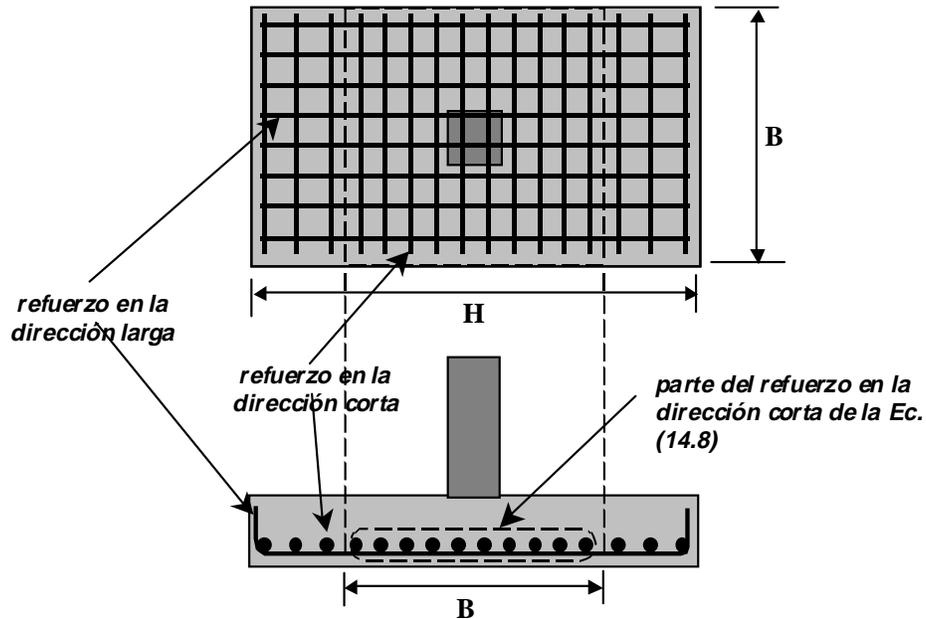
Distribución del refuerzo en zapatas rectangulares aisladas
